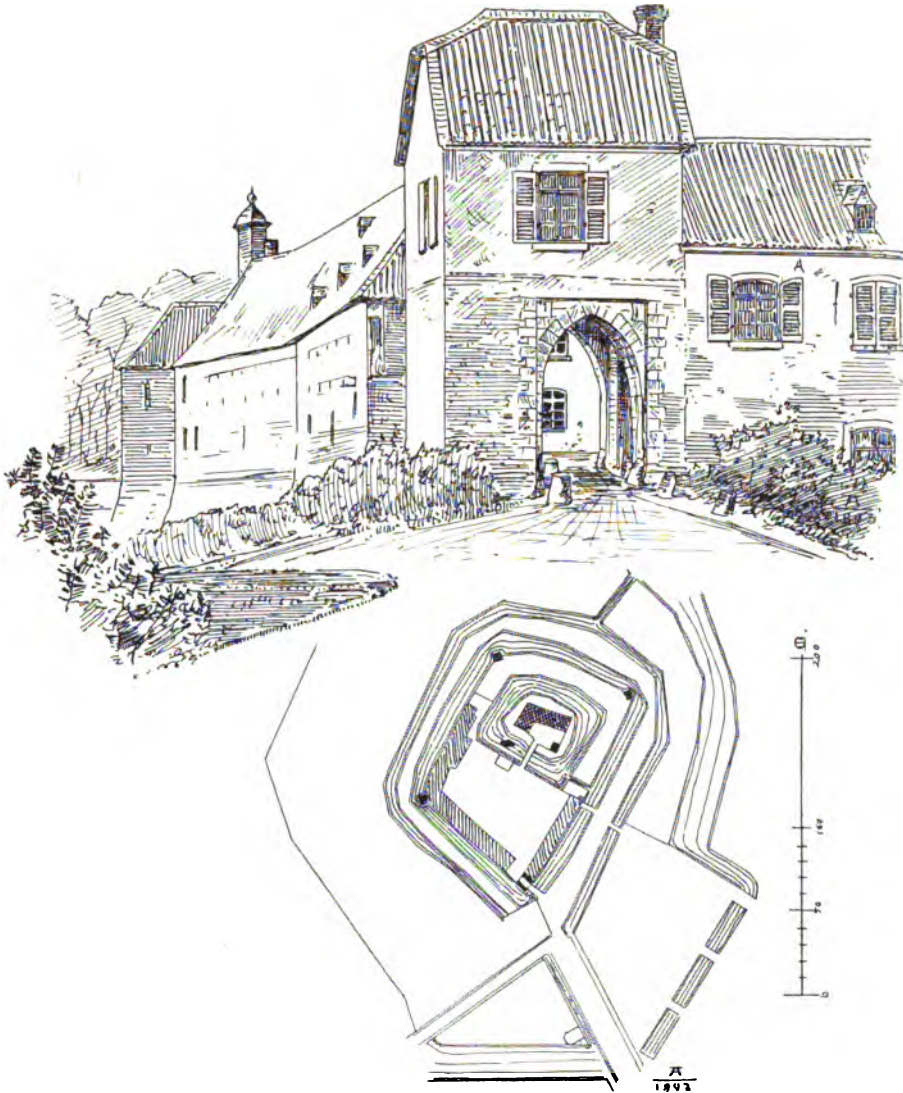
Burg Hemmersbach. Ansicht und Lageplan.
